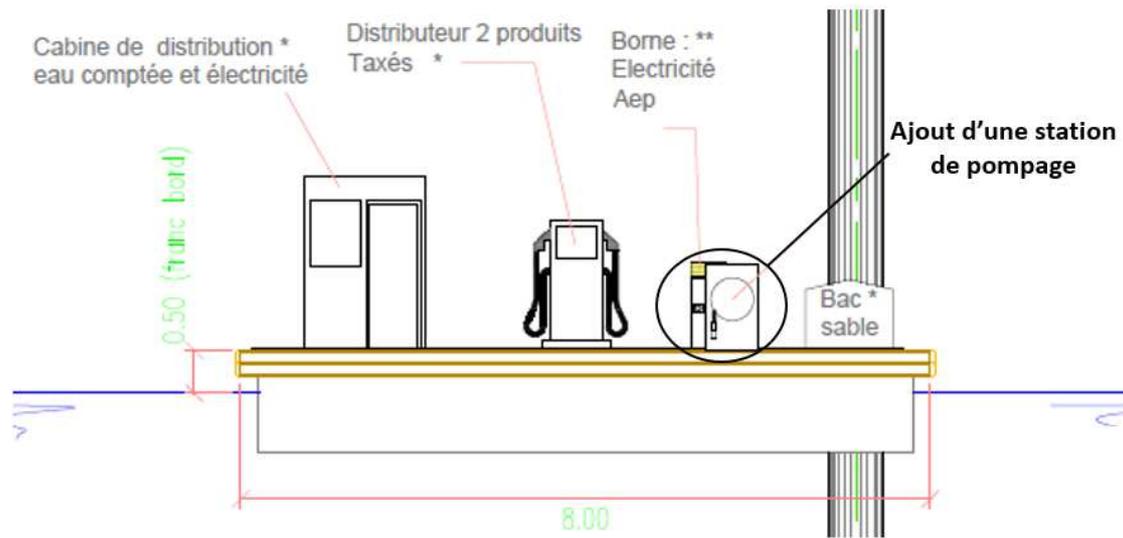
Localisation de la station de pompage sur le ponton équipé de la station d'avitaillement plaisance existante
